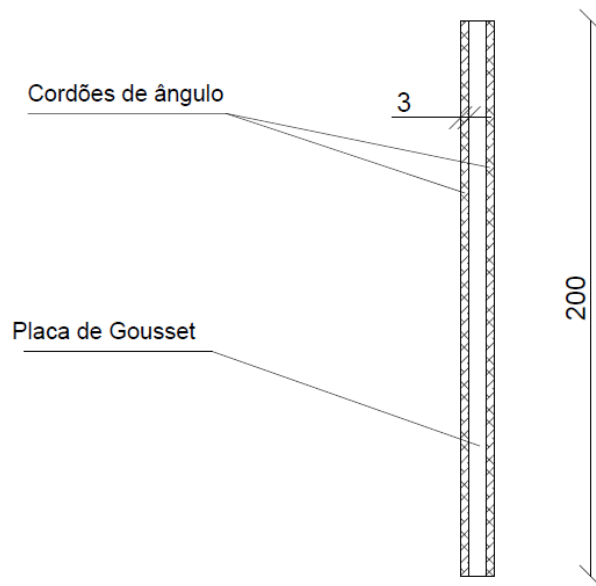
Geometria e posicionamento dos cordões de soldadura – Exemplo de dimensionamento 1.
